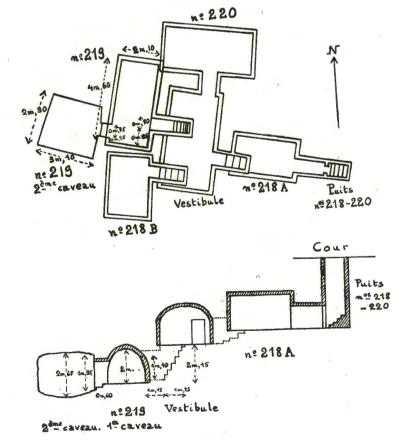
Plan (2) et coupe des caveaux nos 218-219-220.
